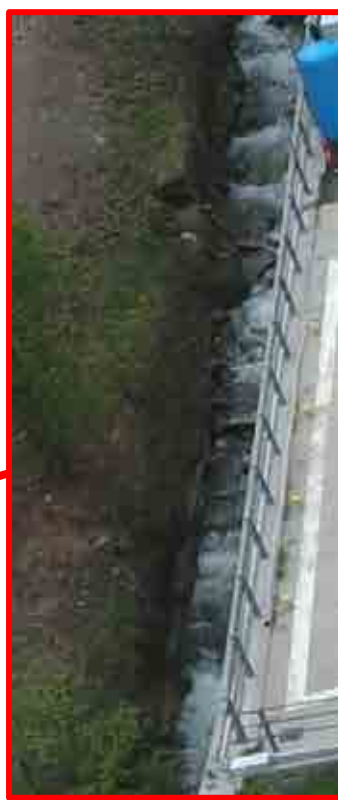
Tratto di intervento nelle condizioni ante evento Alex, con dettaglio della geometria incanalata dell'alveo del rio Panice, costretto tra il muraglione in sinistra e un muretto in pietra subverticale in destra. L'impostazione progettuale attuale prevede invece di ampliare la larghezza di base dell'alveo (circa 5 m a partire dal taglione al piede del muraglione) realizzando poi una scarpata destra in materiale d'alveo (che comprende anche clasti di dimensioni medio-grandi) a modesta pendenza (x:y=2:1).
